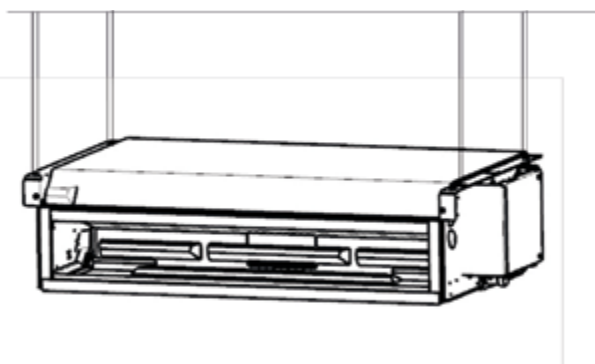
Схеме скрытого потолочного монтажа
